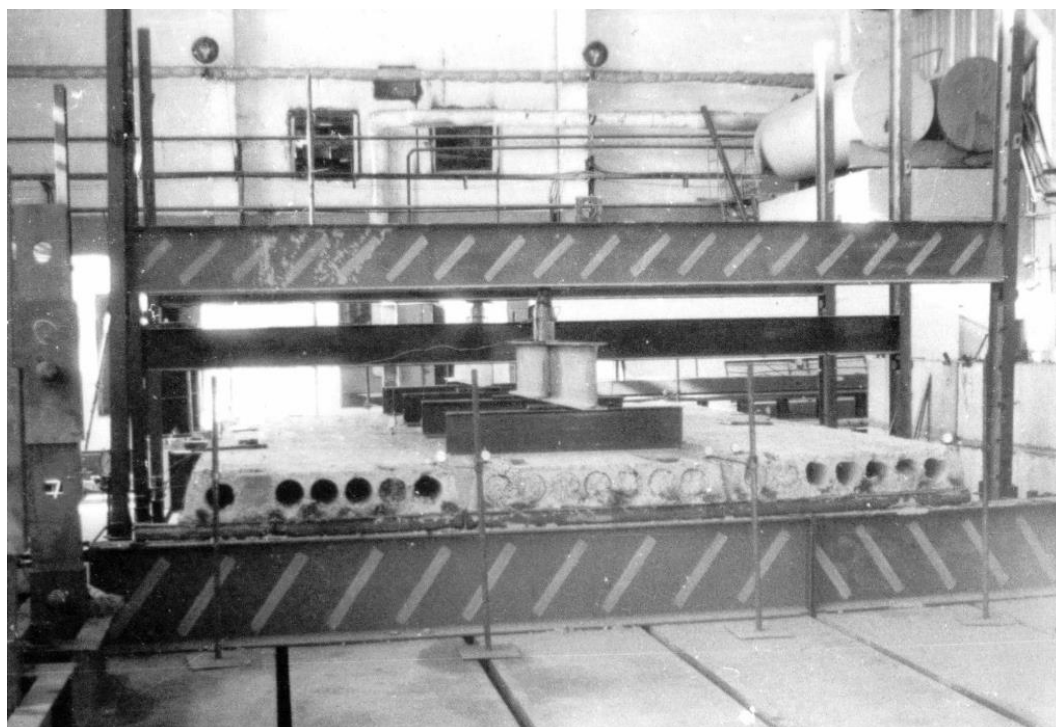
Общий вид испытаний фрагмента перекрытия из многопустотных плит
